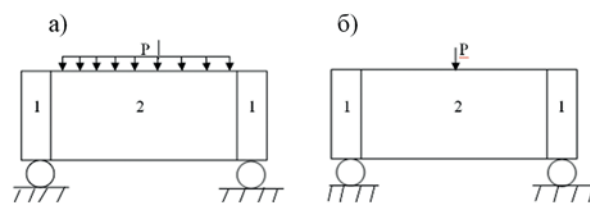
Схемы нагружения образцов: 1 – монолитный блок из универсального цементно-песчаного раствора; 2 - газобетонный блок UDK Block 400 / Samples loading schemes the destruction of the samples
